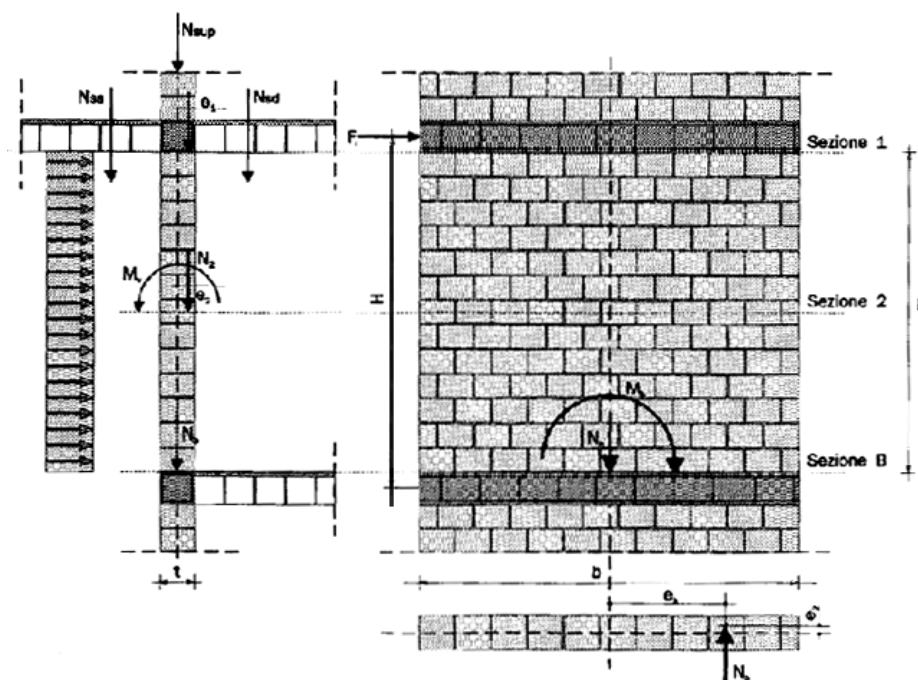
Azioni orizzontali e verticali nelle verifiche della parete (12).
